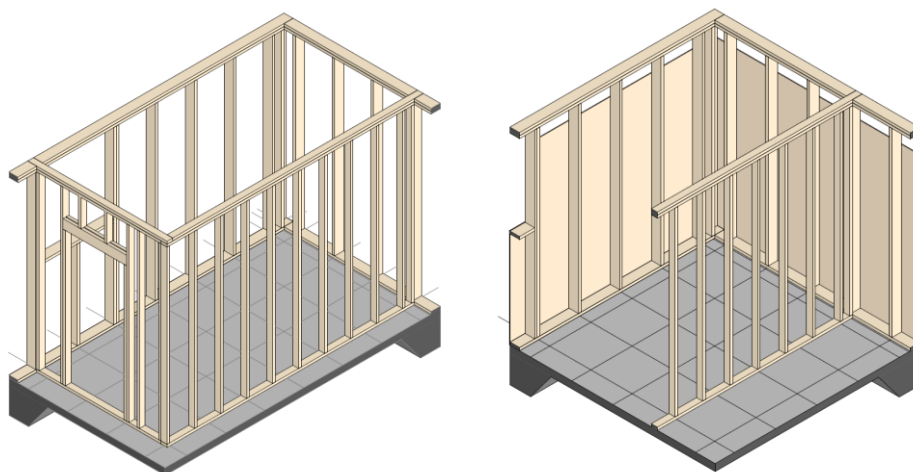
Encontro de canto entre duas paredes exteriores e duas paredes interiores, com revestimento estrutural em OSB pelo exterior na imagem da direita.
